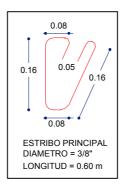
ESTRIBO DE VIGA AÉREA
